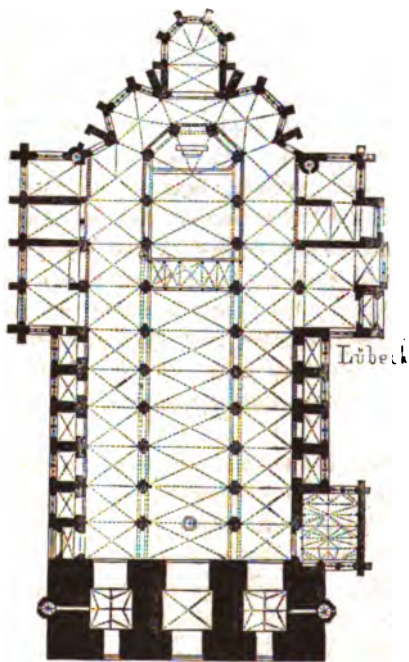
Grundriss der Marienkirche zu Lübeck.
